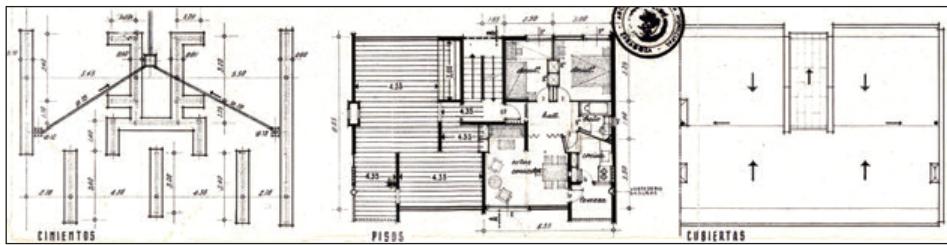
Módulo tipo. Plantas de cimentación, vivienda y cubierta. Fragmento de plano de Proyecto, 1958. A.M.Z., Sección de Urbanismo, no. exp. 30180/58, caja 200923.
